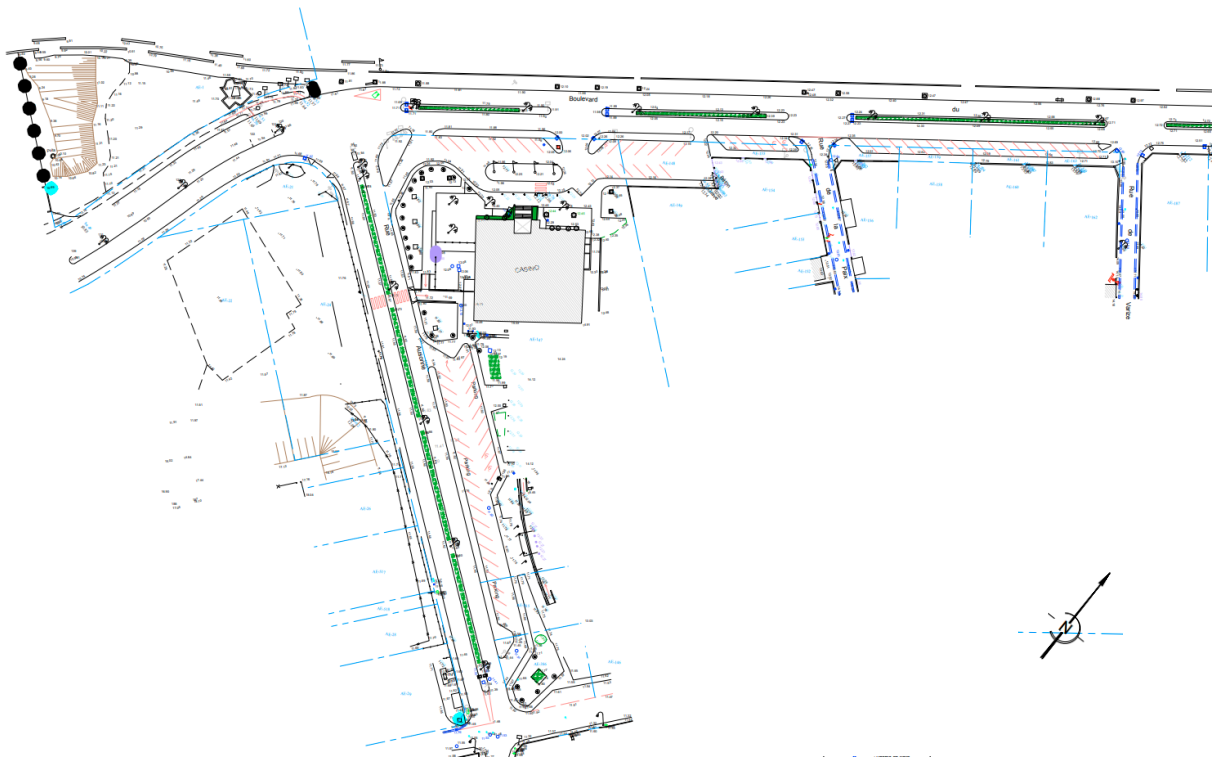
Plans de l'existant avant travaux (portion 1) (Source : PRO -juin 2018)
